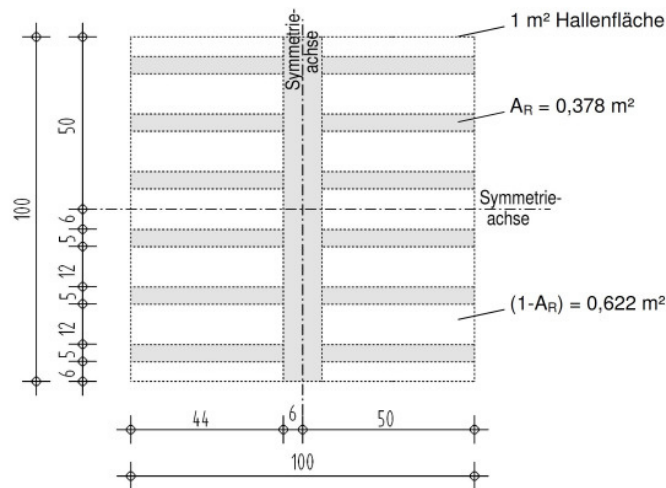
Grundrissdarstellung (Ausschnitt 1 m²) des Deckenrosts der offenen Eissporthalle Bergheim
